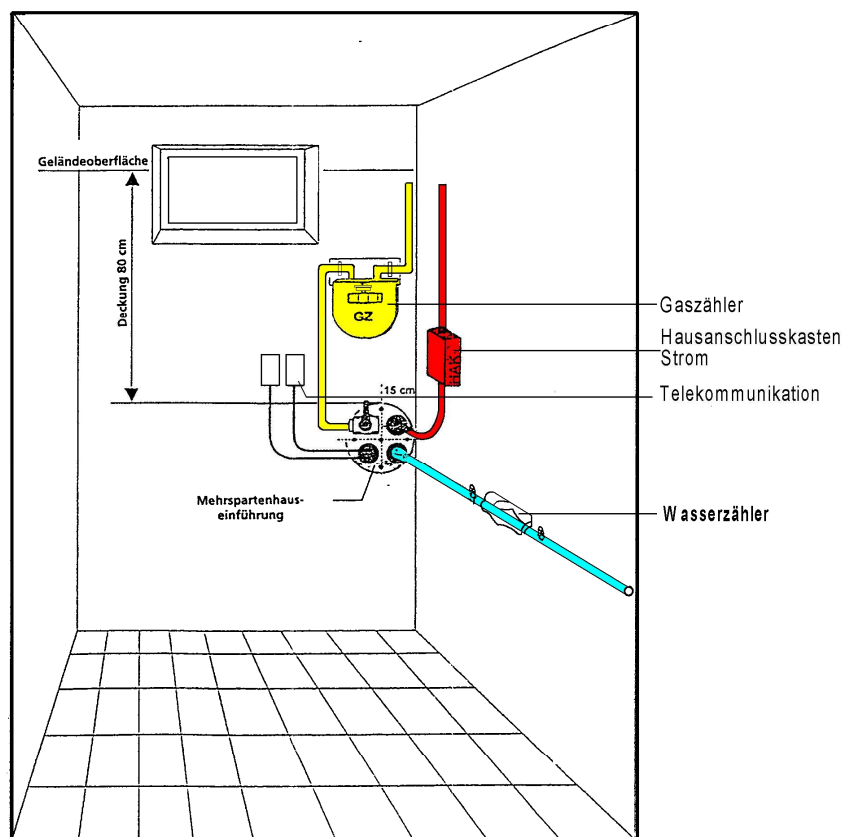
Hausanschlussraum mit Mehrspartenhauseinführung
